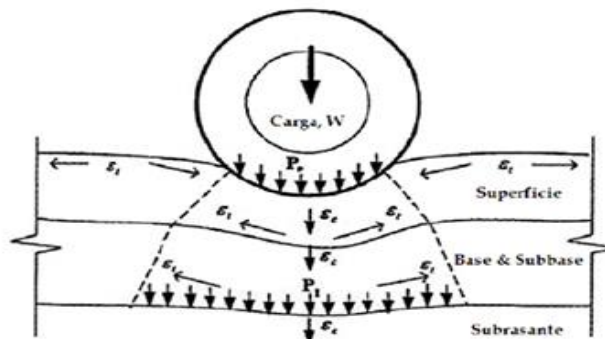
Deformaciones en pavimentos flexibles y distribución de cargas
